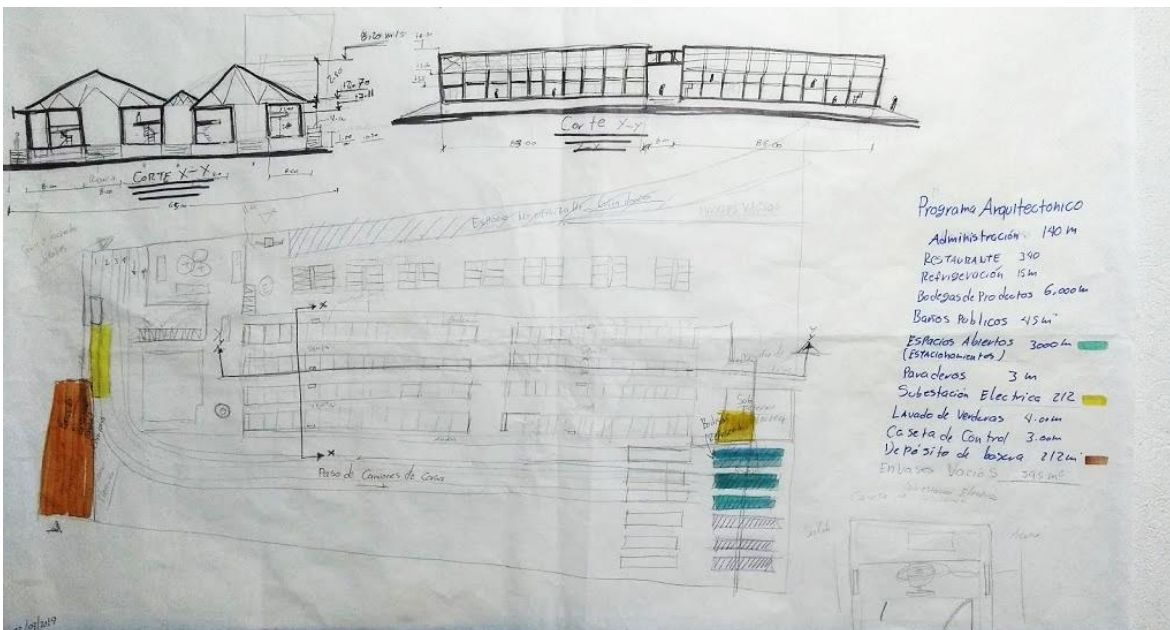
Foto reubicación de planta de conjunto. Fuente: elaboración propia.
